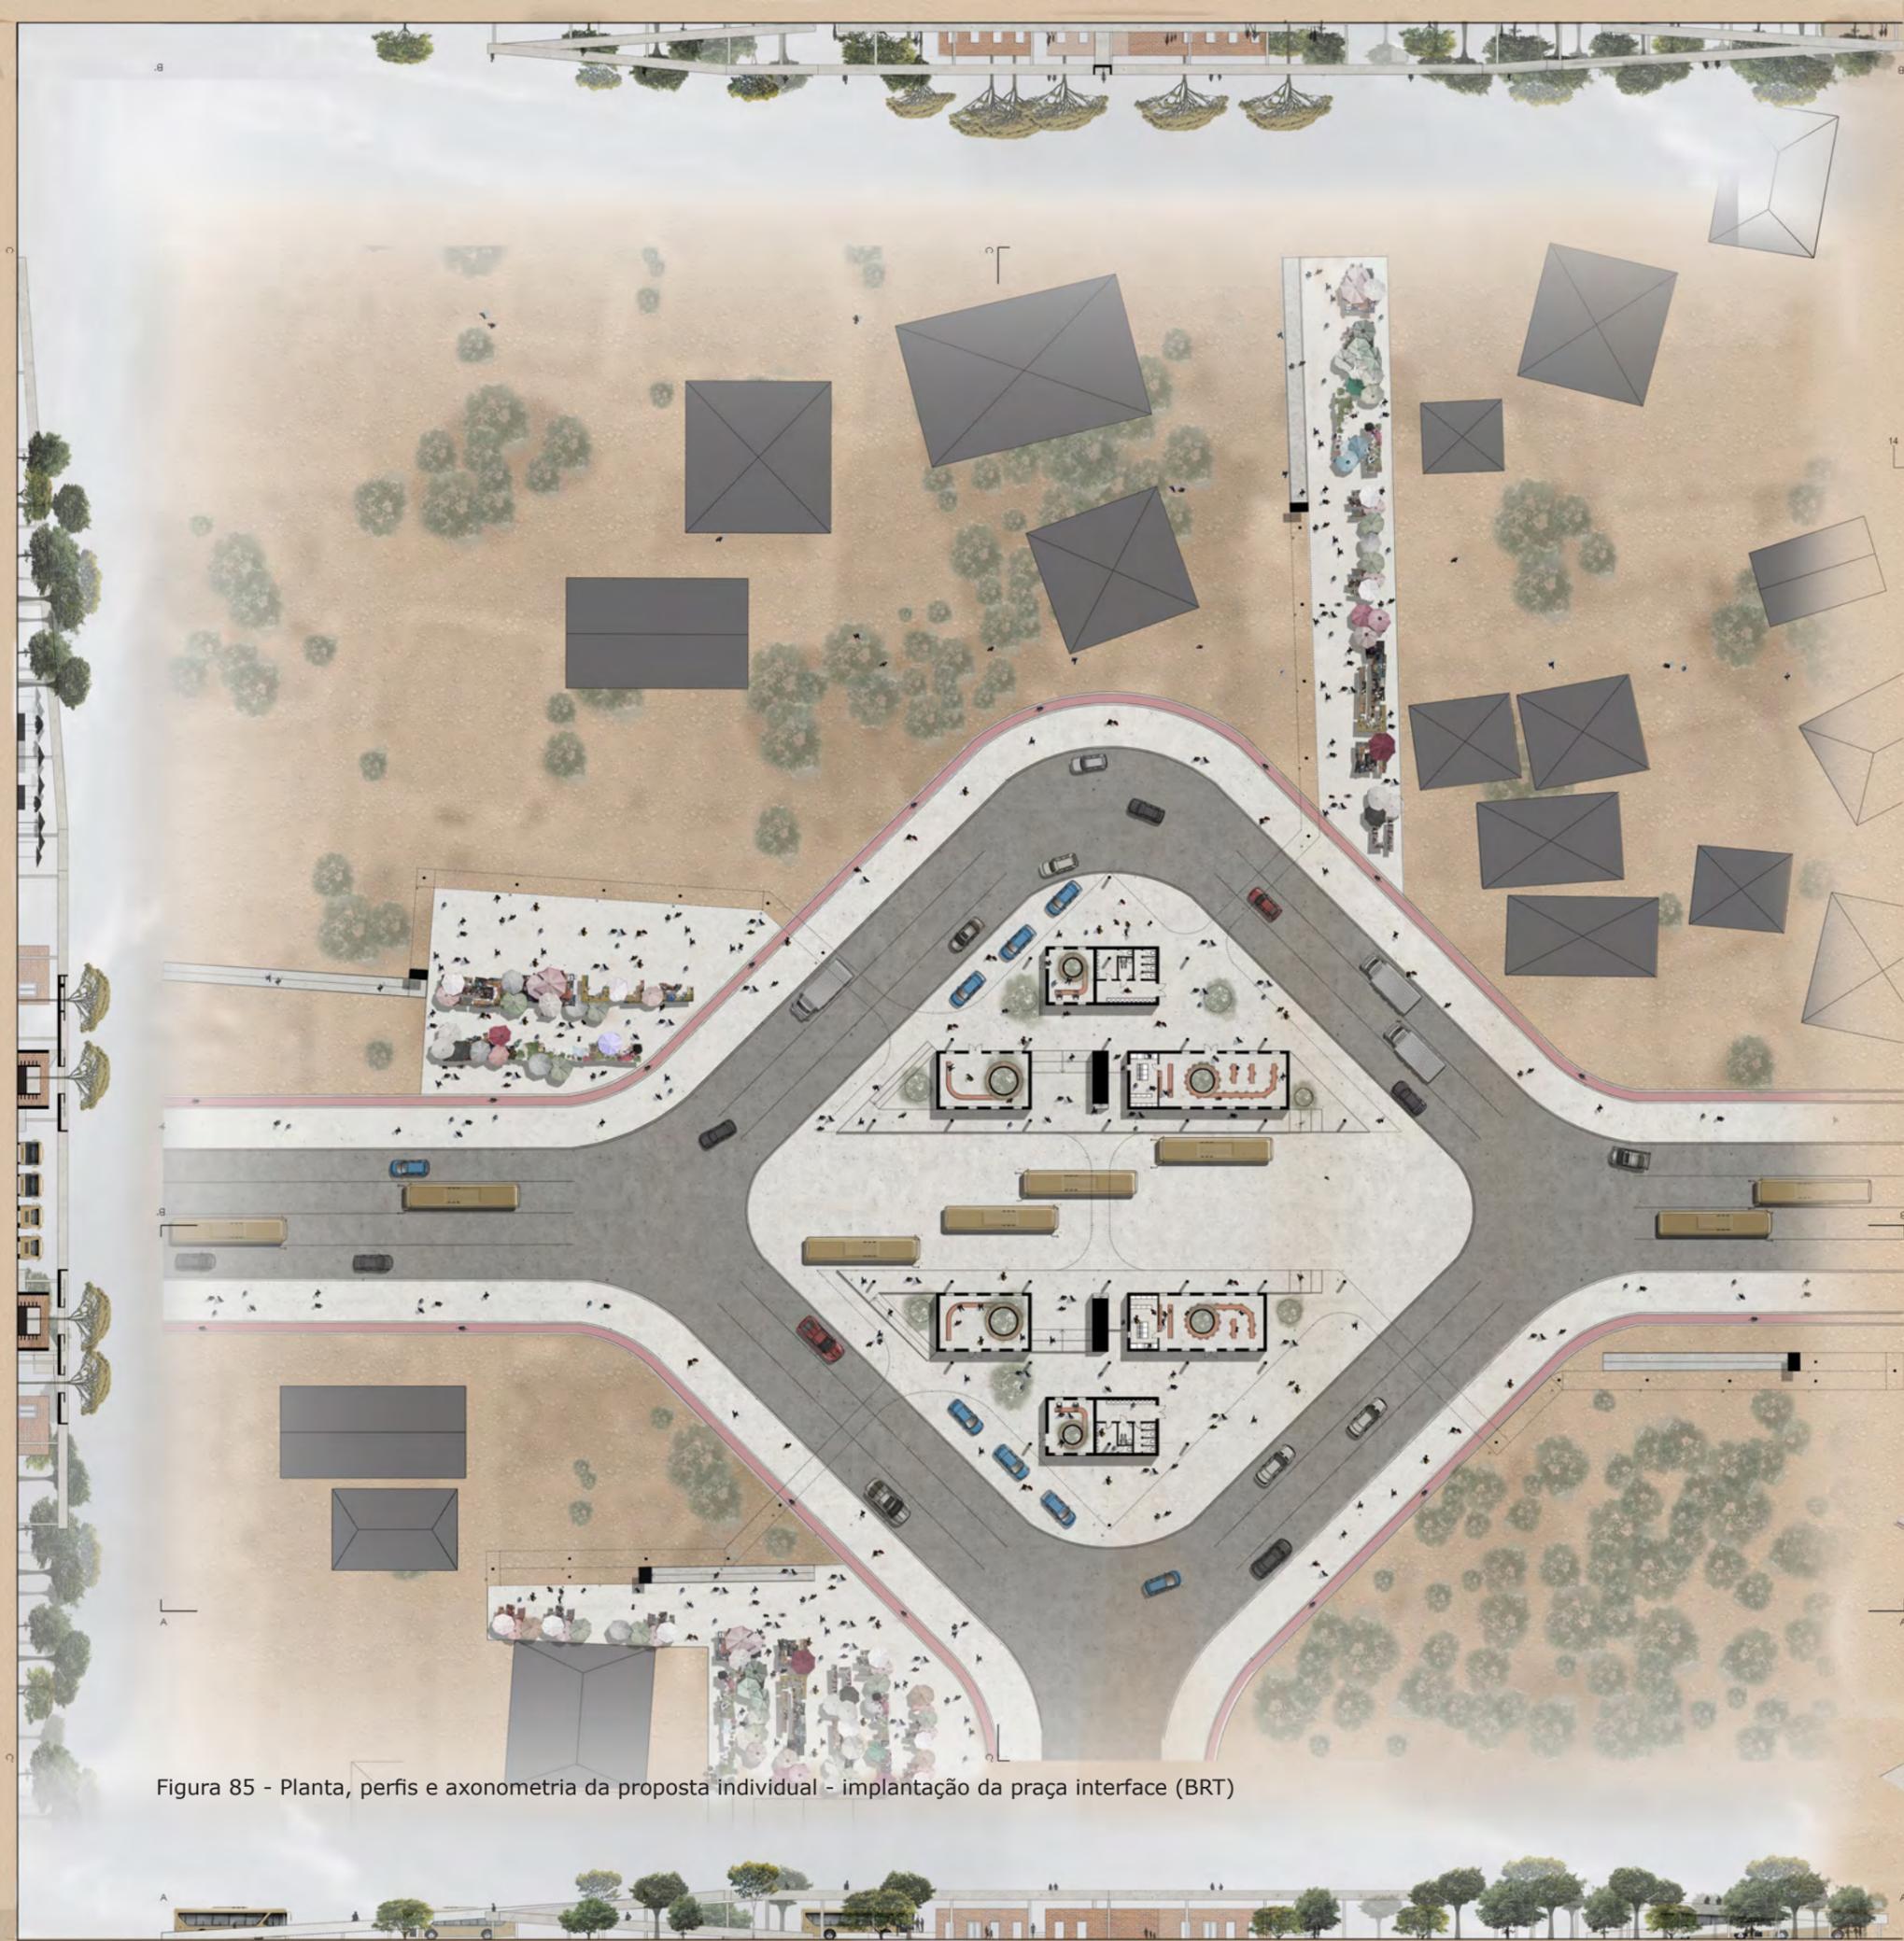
Planta, perfis e axonometria da proposta individual - implantação da praça interface (BRT)
